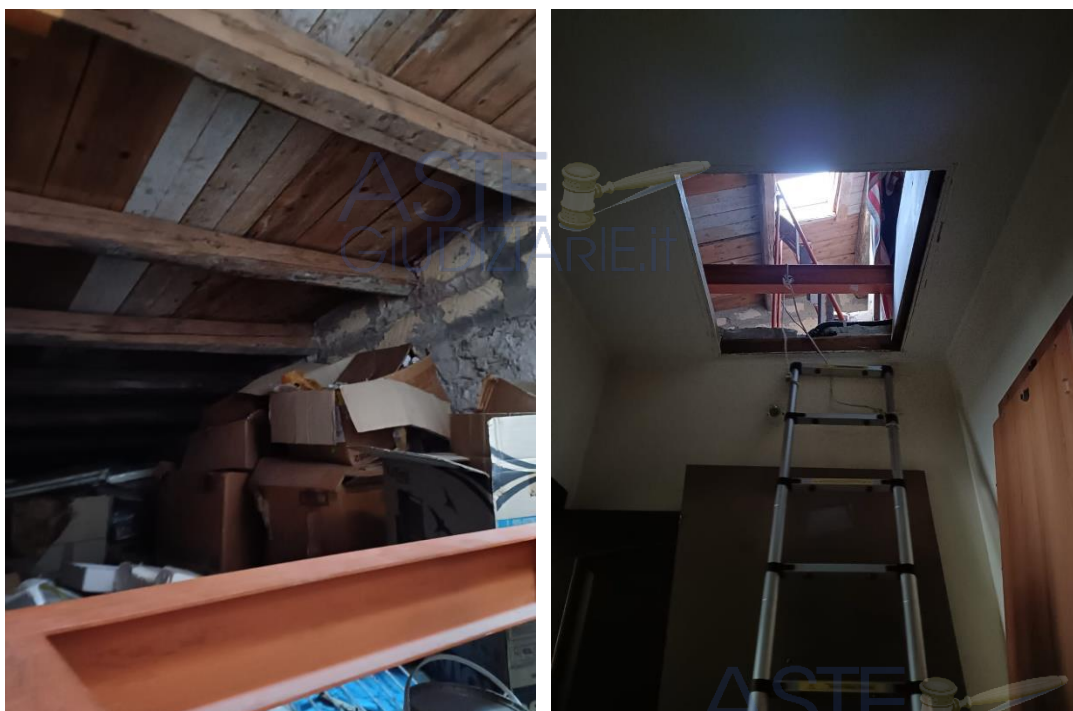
Piano secondo. Vista dal basso del sottotetto non praticabile
